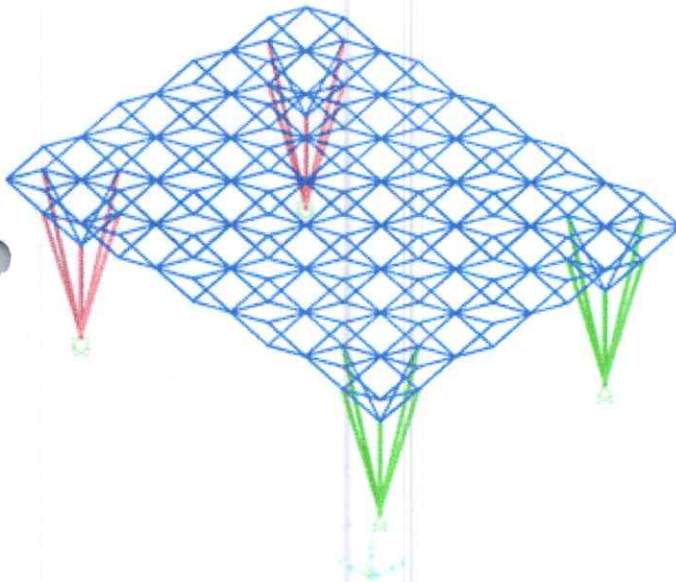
Estructura desplegable analizada en software de análisis estructural elaborado por el Ing. estructural Fernando Sanchez Yamunaqué.
